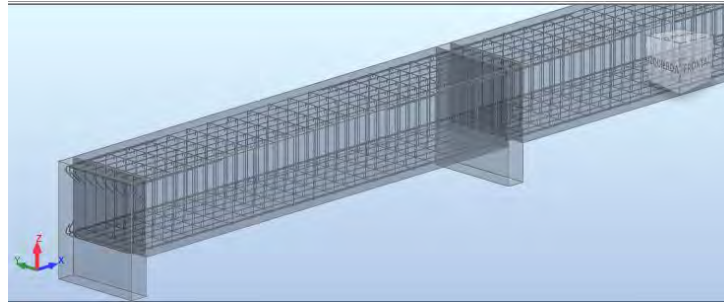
DETALLE DE ARMADURA DE LA VIGA
